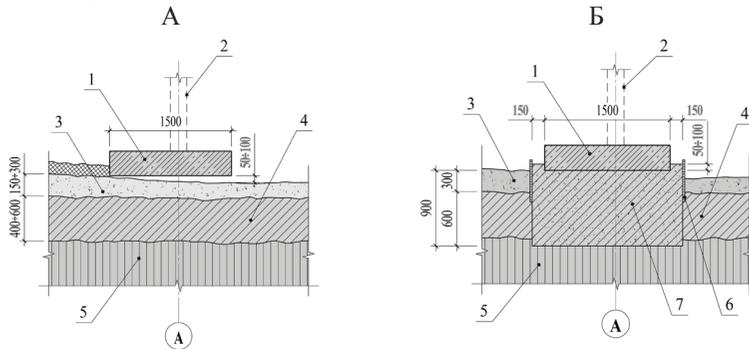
А – схема разрушения песчано-гравийной подсыпки и насыщения водой несущего слоя грунтового основания под наружной стеной, ориентированной по оси «А»; Б – схема замены слабого несущего слоя грунтового основания цементным раствором: 1 – плитная часть фундамента; 2 – фундаментная стена; 3 – песчано-гравийная подсыпка; 4 – текуче-пластичный суглинок; 5 – суглинок в первоначальном природном состоянии; 6 – опалубка; 7 – массив из цементно-песчаного раствора
